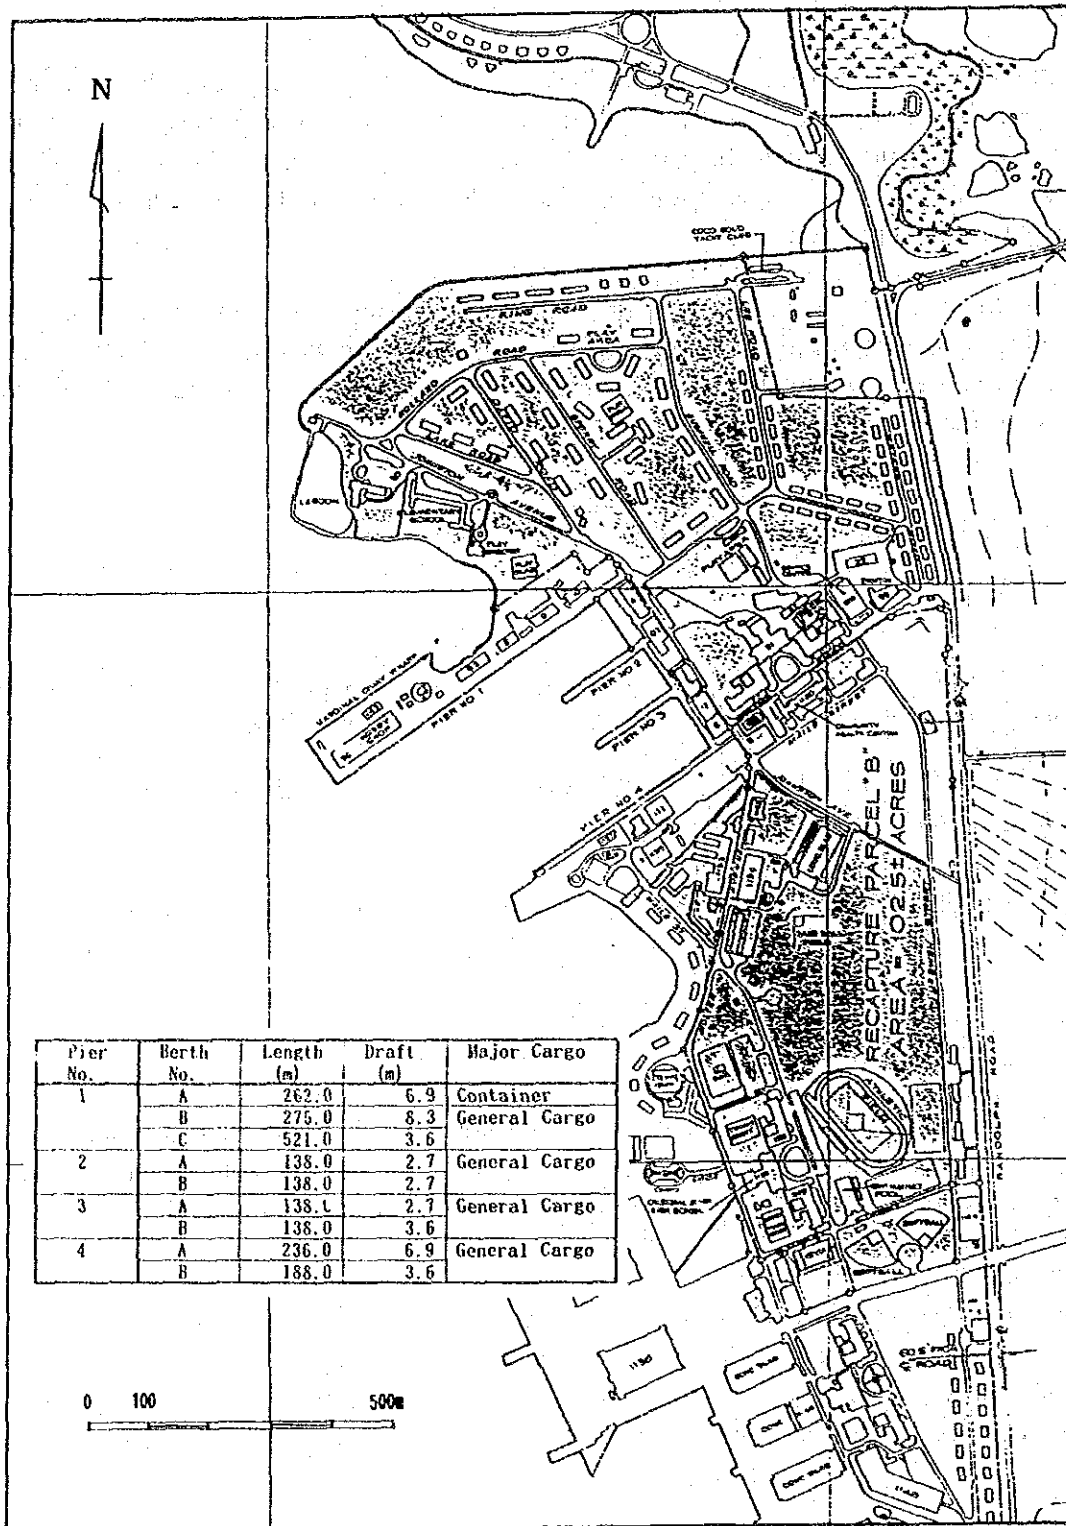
Planos del Puerto de Coco Solo Norte
